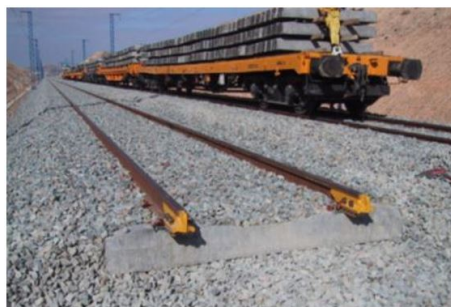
Colocación de bridas para la unión de la rampa con la vía general
